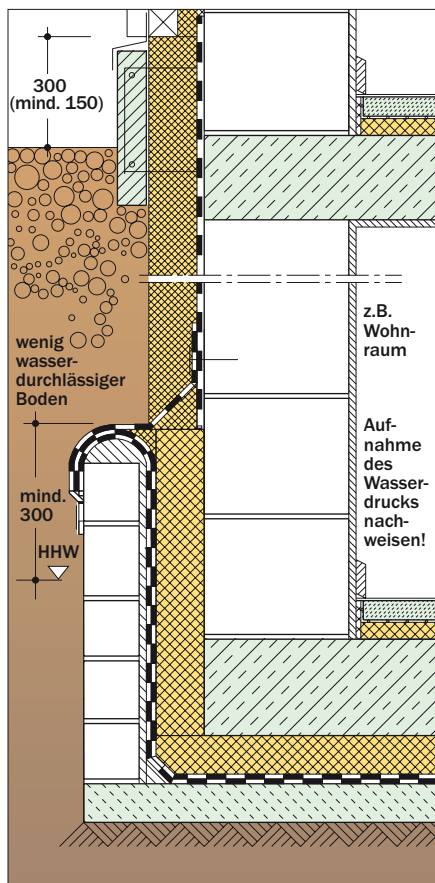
Grundwasserwannen eines gemauerten Kellers mit geringer Eintauchtiefe unter dem Bemessungswasserstand
